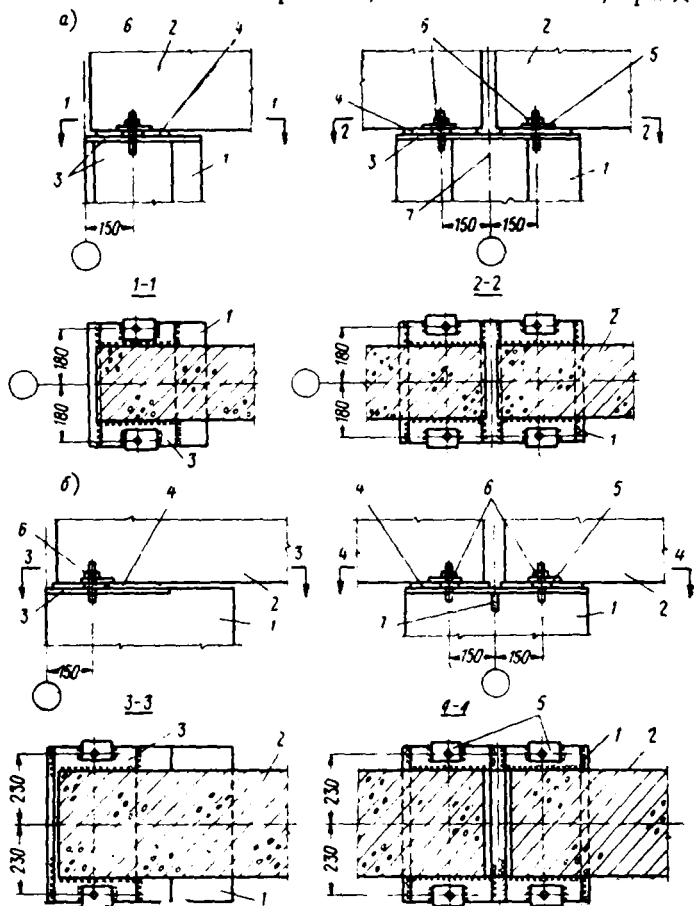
Детали сопряжений стропильных конструкций покрытий с колоннами по крайним и средним рядам, привязка анкерных болтов
